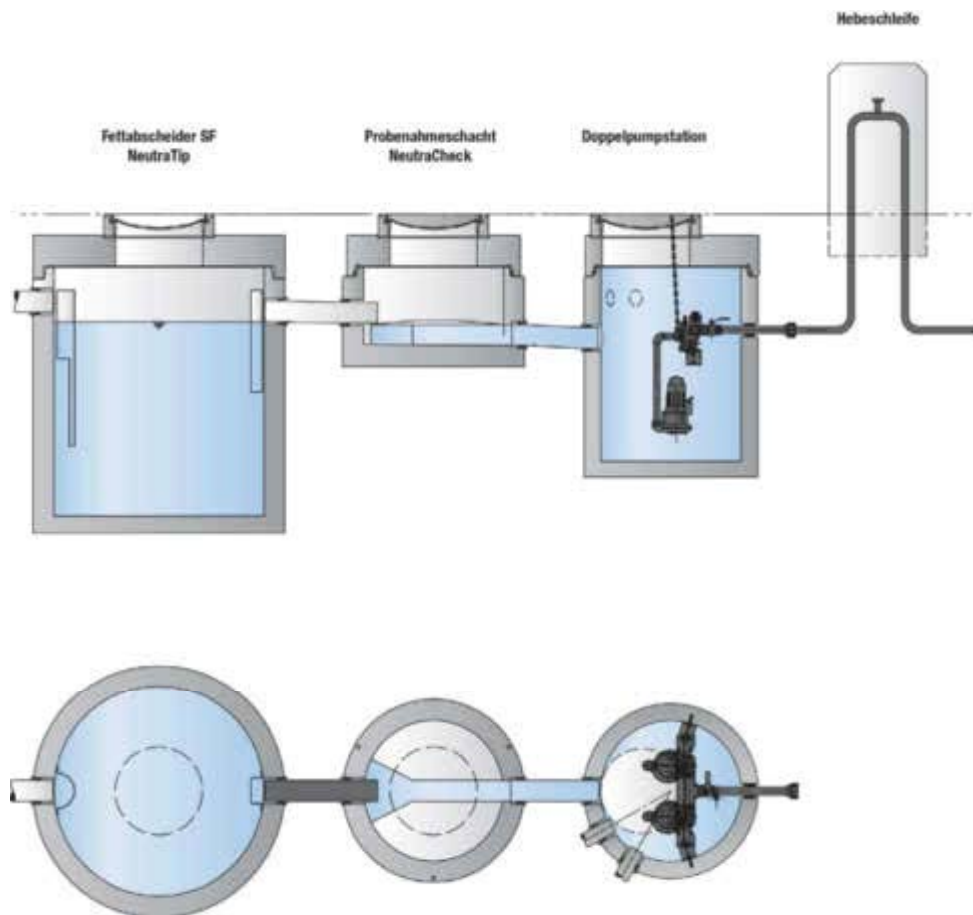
Fettabscheider zum Einbau ins Erdreich
